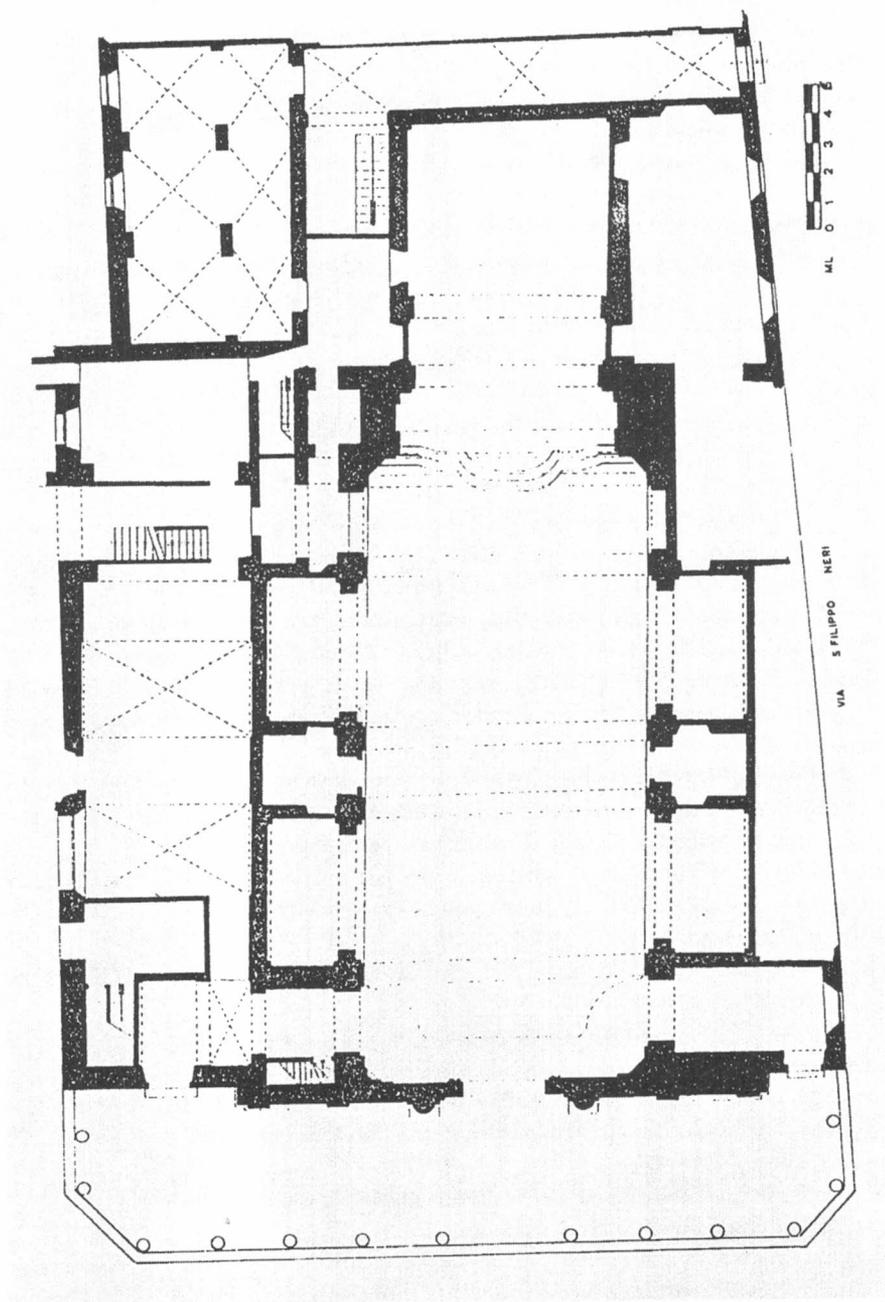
FAENZA, Chiesa del Suffragio. Planimetria (disegno di V. Maggi)
